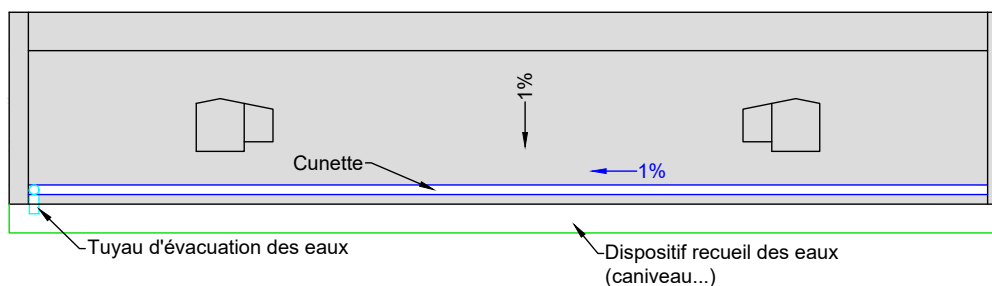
Ajout d'une bordure pour guider l'eau de ruissellement
